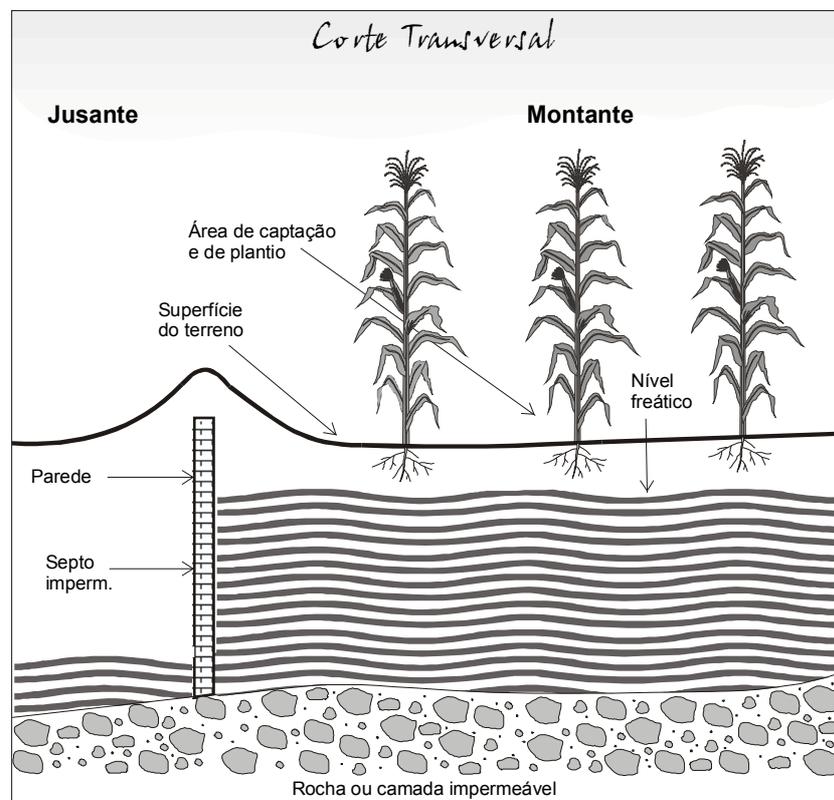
Desenho esquemático de exploração de barragem subterrânea.
